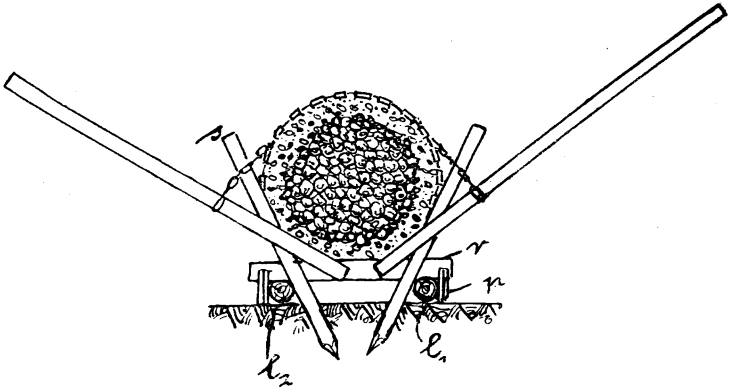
Senkrechter Querschnitt durch die Senfmaschinenbank und Senfmaschine.
